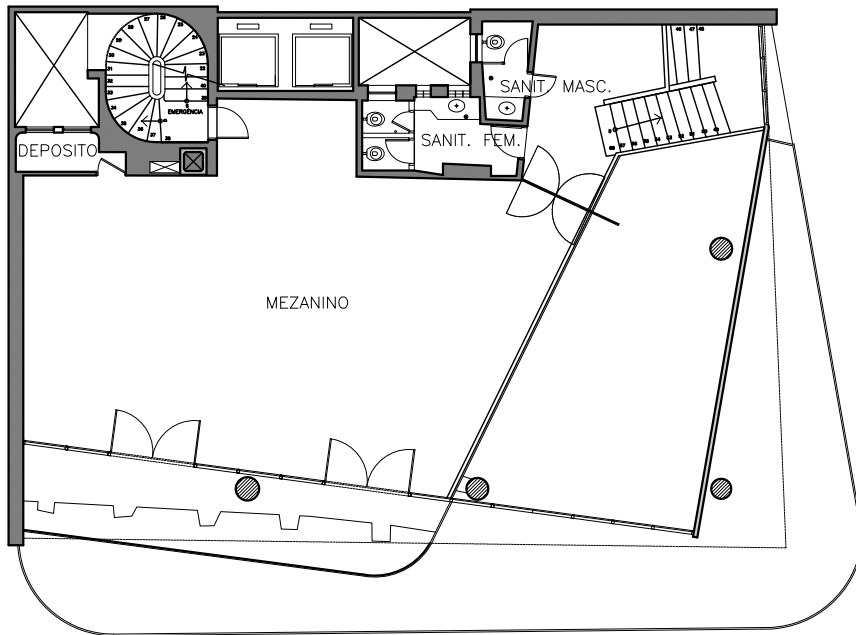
Planta da marquise superior após a remoção do entulho - 1:200
